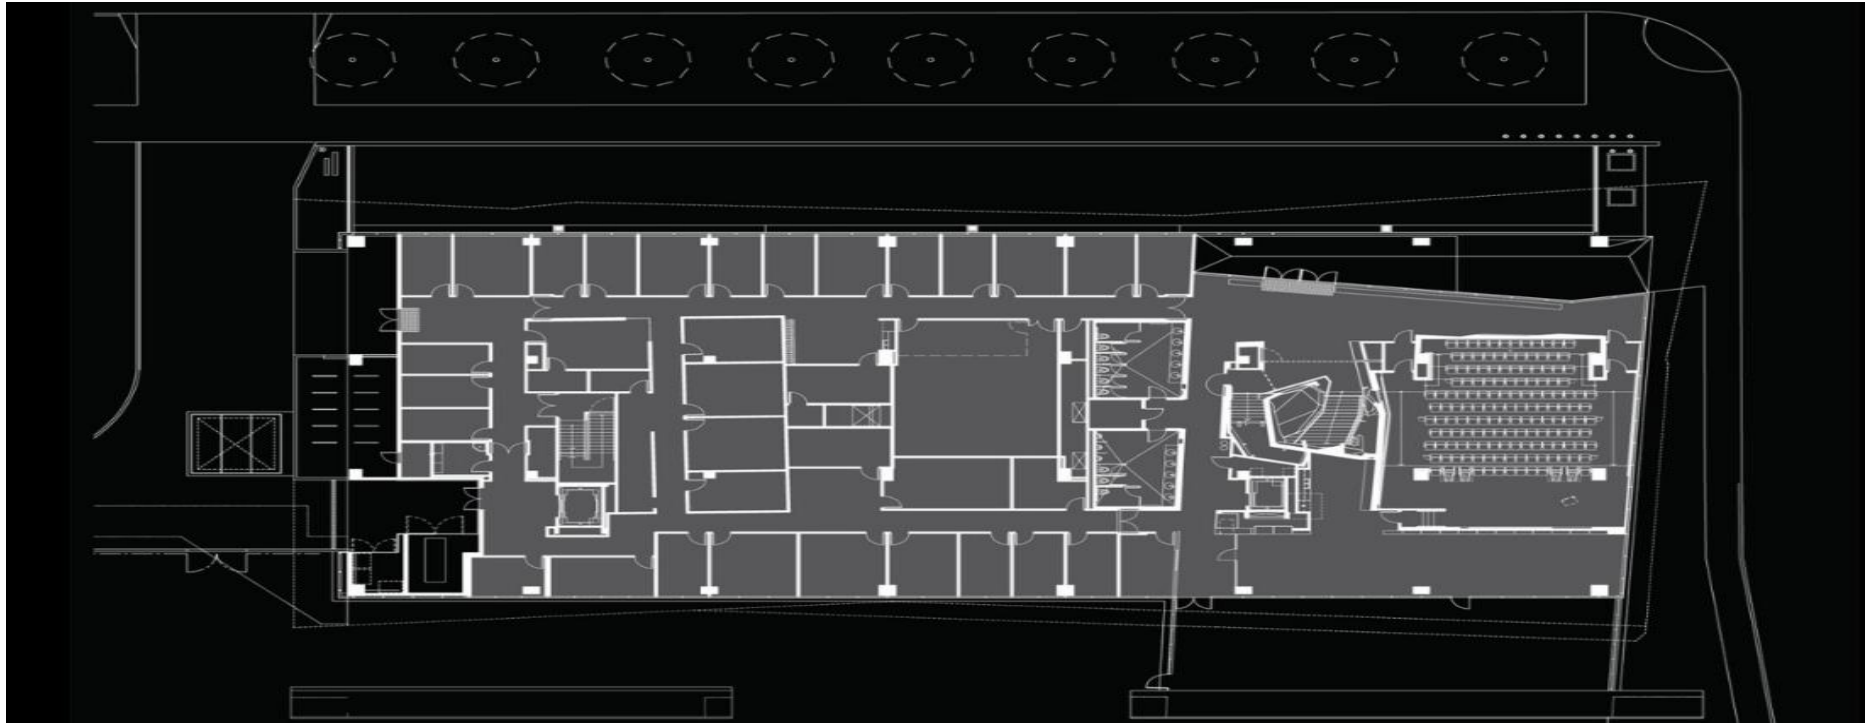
Planta Arquitectónica del Centro Cahill
